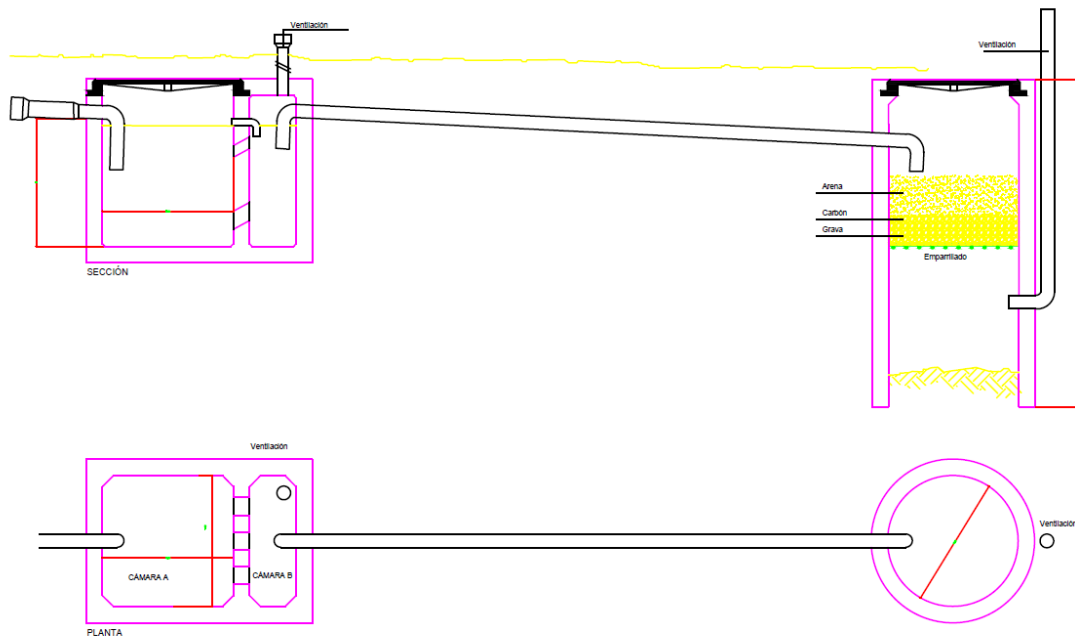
vista en planta y corte transversal de cámara séptica + pozo absorbente
